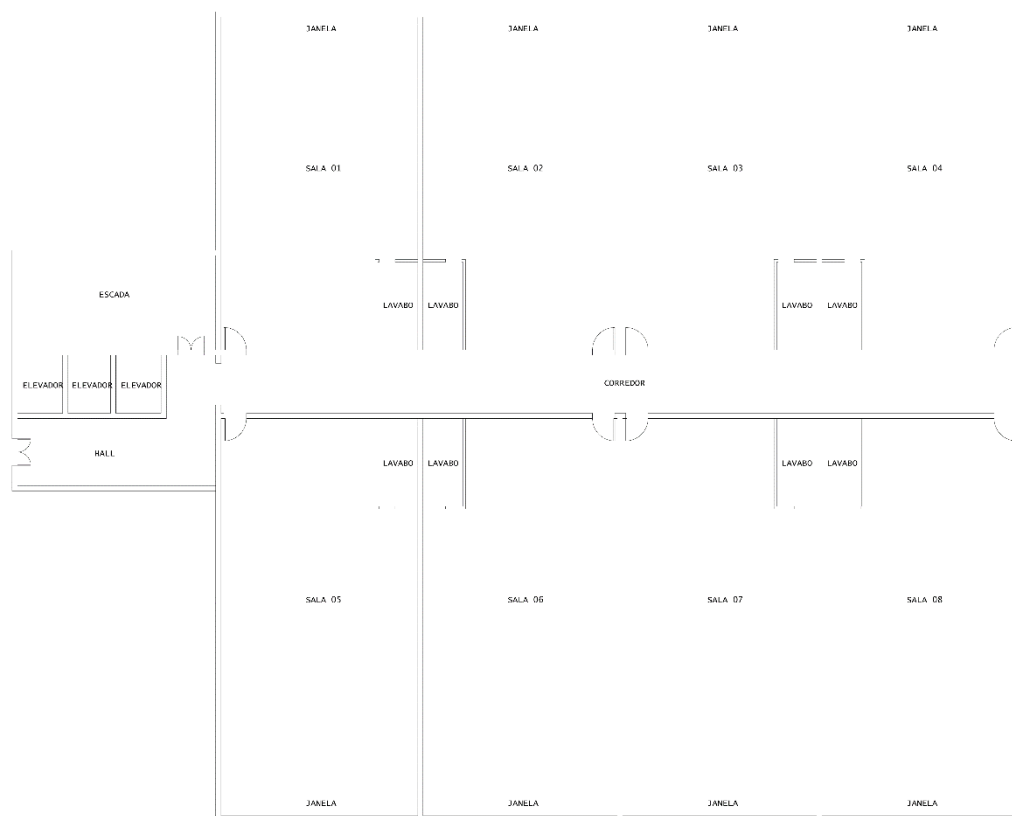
Planta arquitetônica simplificada do pavimento tipo dos modelos com malha 7,5x7,5m
